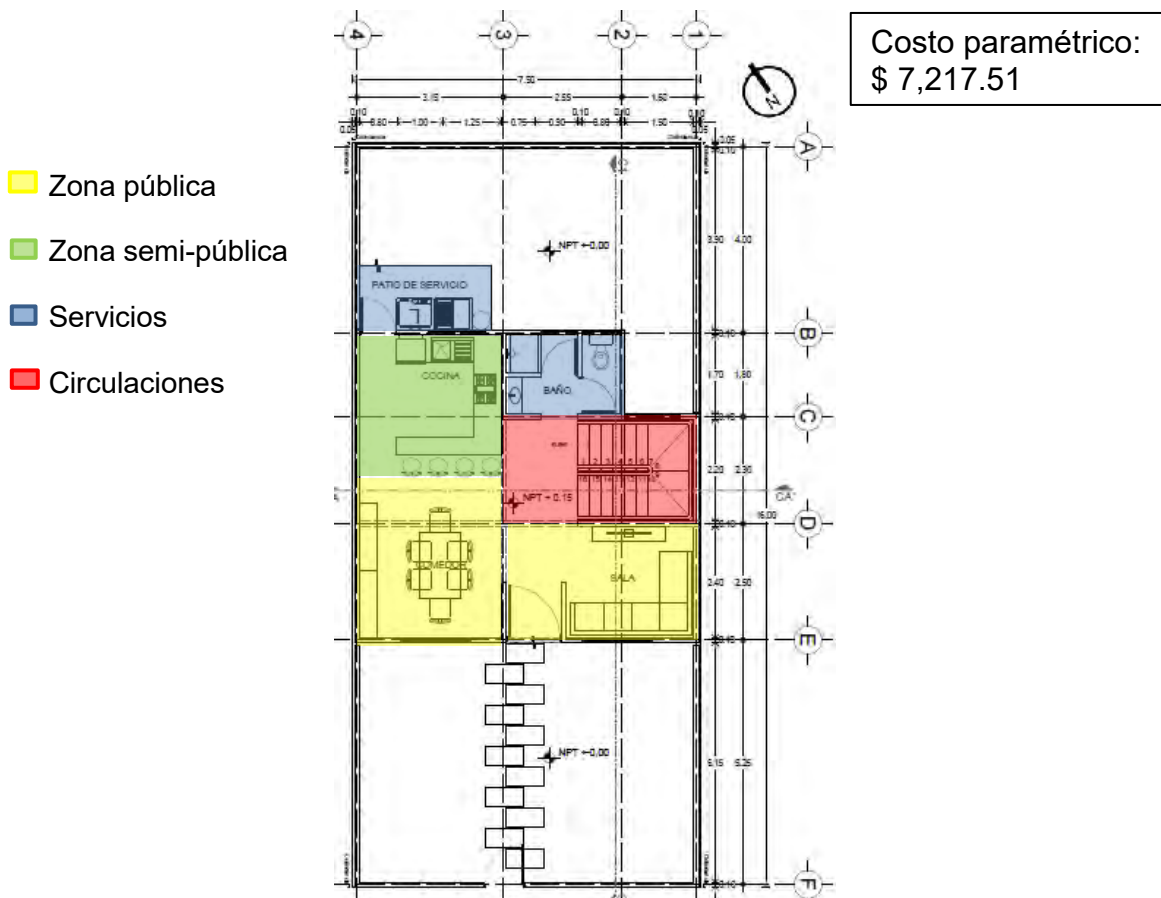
Planta arquitectónica de prototipo de vivienda B1. Segunda etapa, planta baja.
